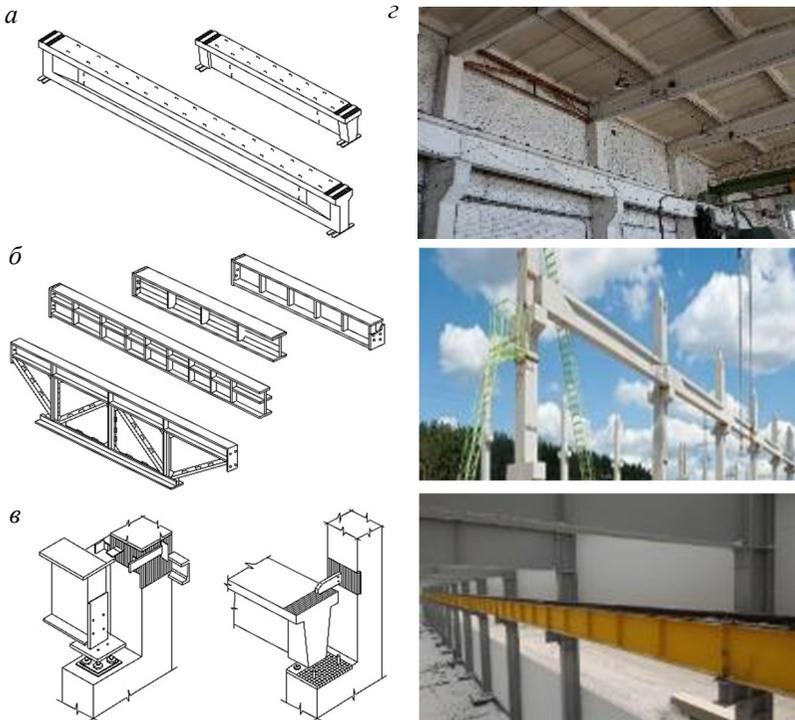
Подкрановые балки: *а* — железобетонные таврового и двутаврового сечения; *б* — металлические разрезные двутаврового сечения и решетчатая; *в* — узлы крепления к колонне; *г* — примеры применения
